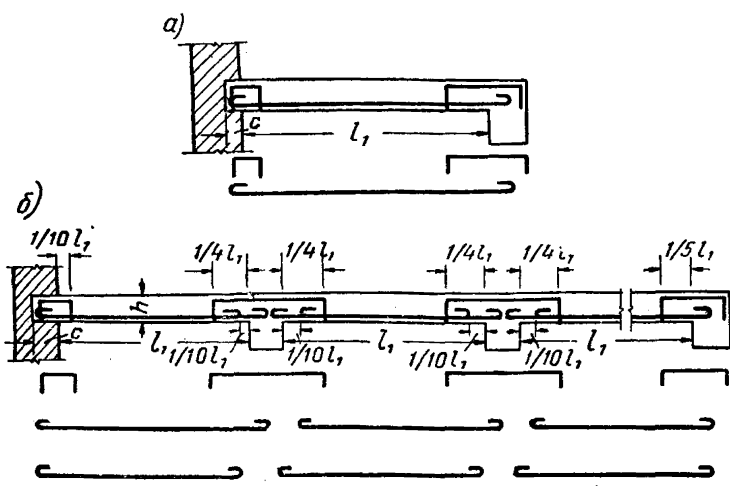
Армирование плит вязаной арматурой при отсутствии отгибов (при применении для арматуры стали периодического профиля крюки на концах стержней не устраивают)
